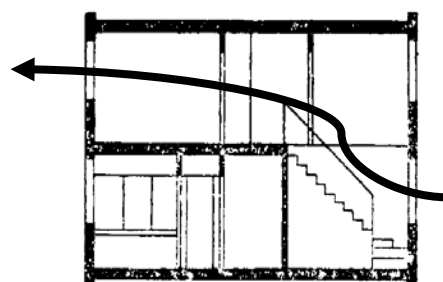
Схема проветривания помещений в посредством лестничного узла в двухуровневой квартире.
